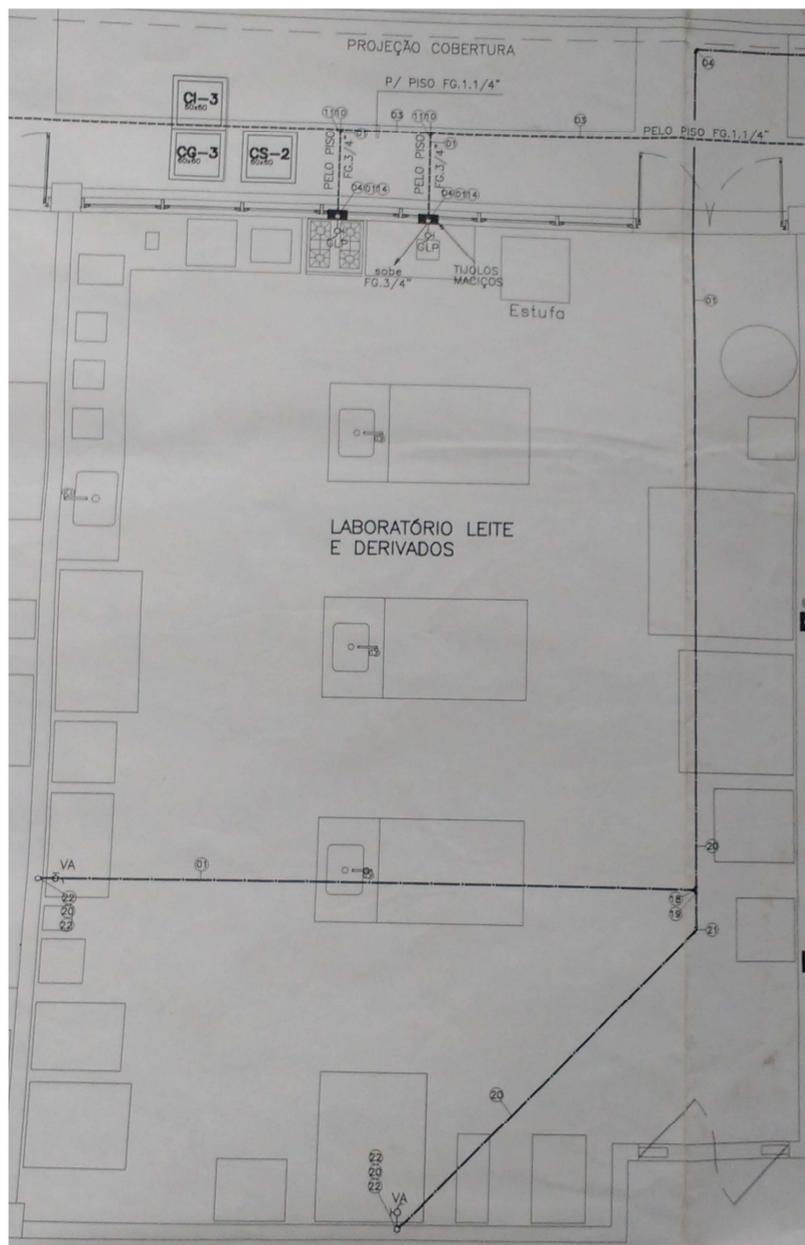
Planta baixa da Planta Piloto de Produtos Lácteos
